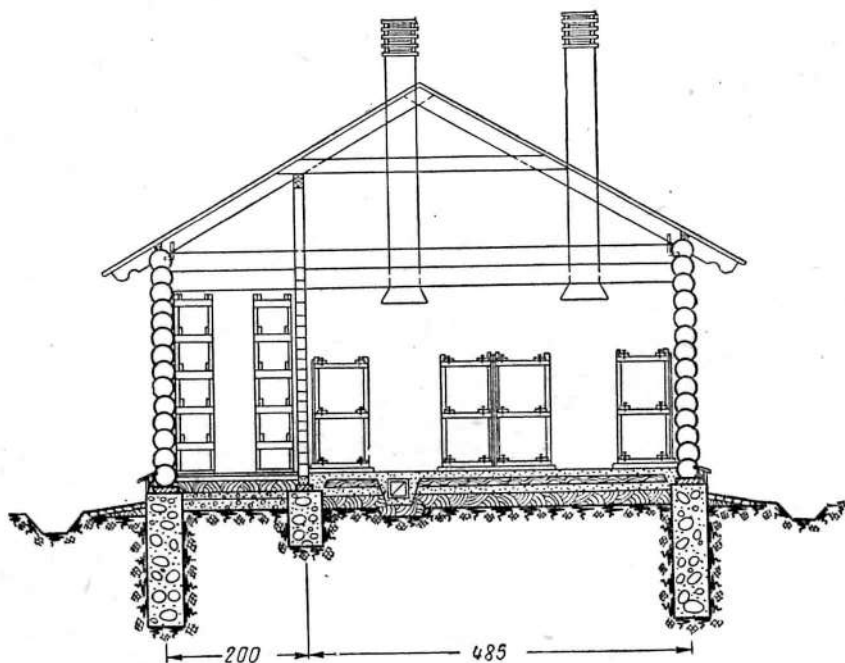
Поперечный разрез надземного зимовника на 162 пчелиные семьи с сотохранилищем (размеры в см).
